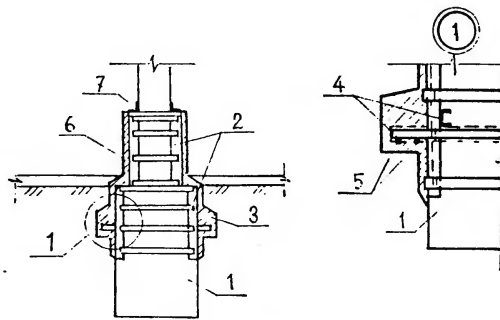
Увеличение опорной площади и усиление бетонного фундамента
